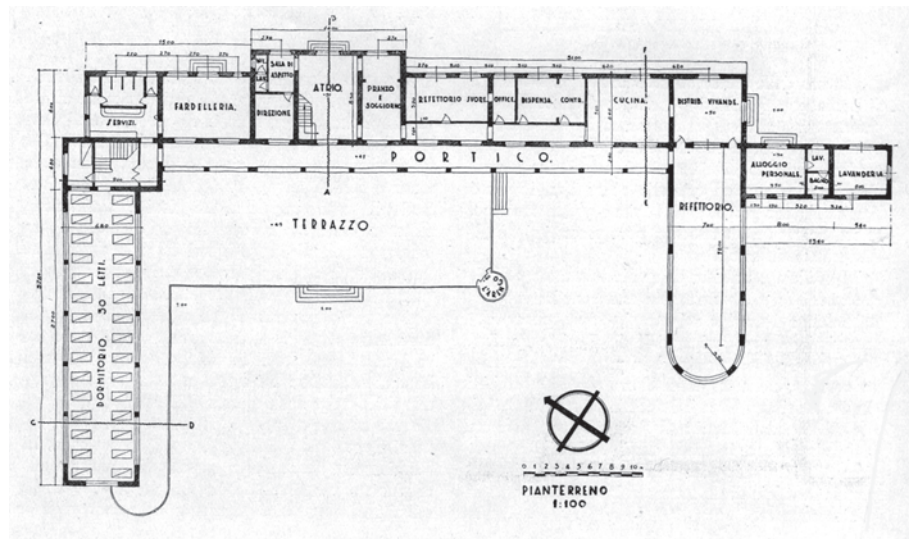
Ferienkolonie „Principe di Piemonte“: Grundriss EG
